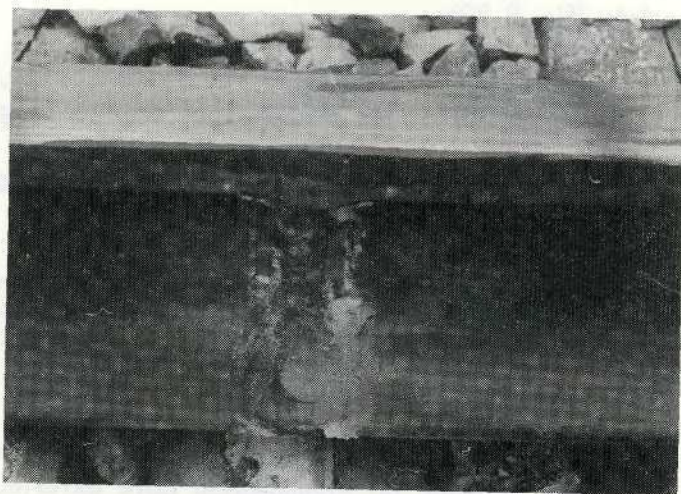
Soudure terminée avec le bossage caractéristique de la soudure aluminothermique.
